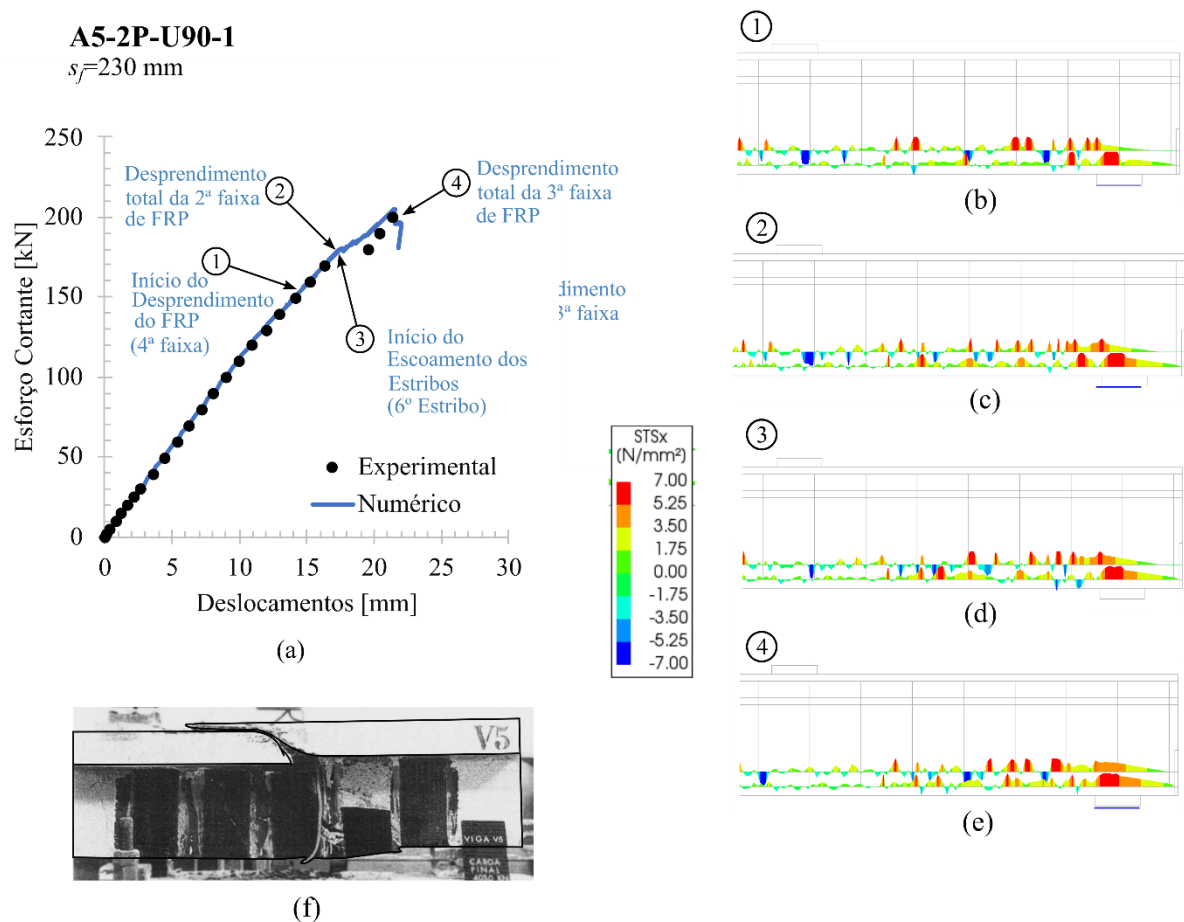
Tensões de aderência entre concreto e armaduras longitudinais para a viga A5-2P-U90-1.
